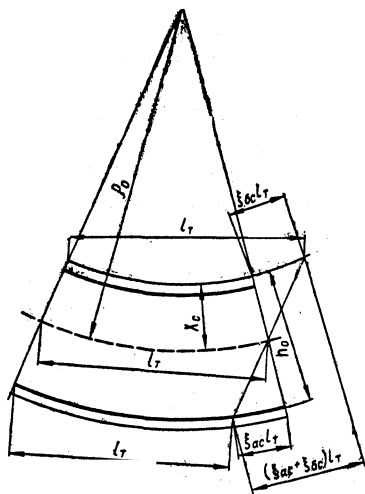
Деформация железобетонного элемента на участке между трещинами.
